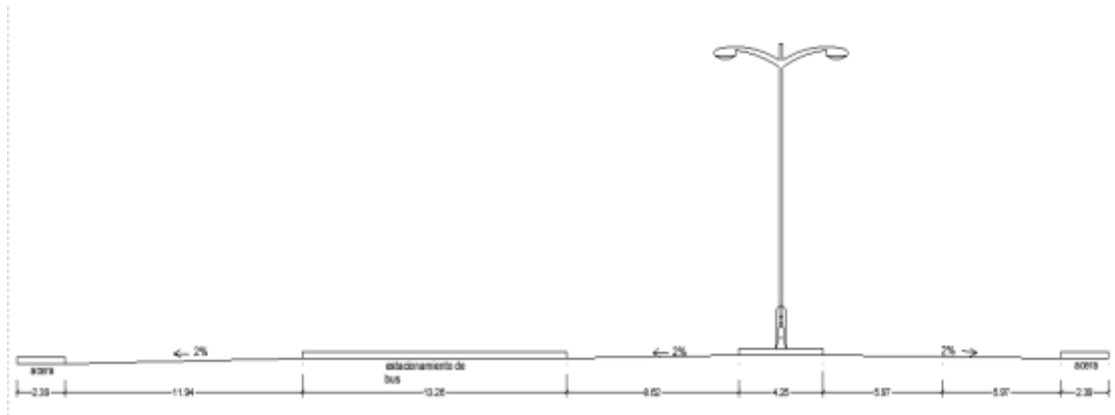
Sección transversal Tramo 3-4 Avenida Norte Sur 71
